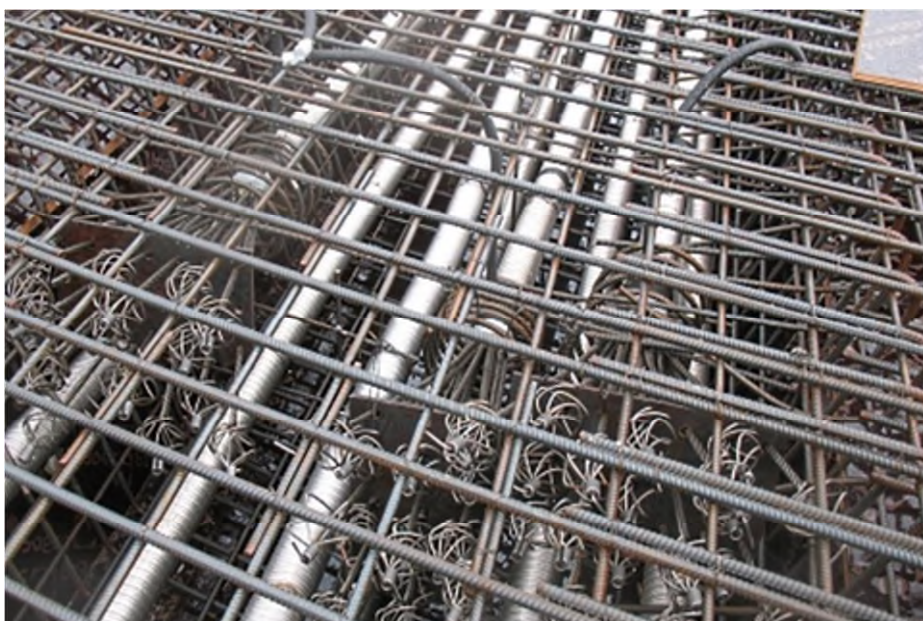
Фрагмент плити перекриття зі змішаним армуванням
